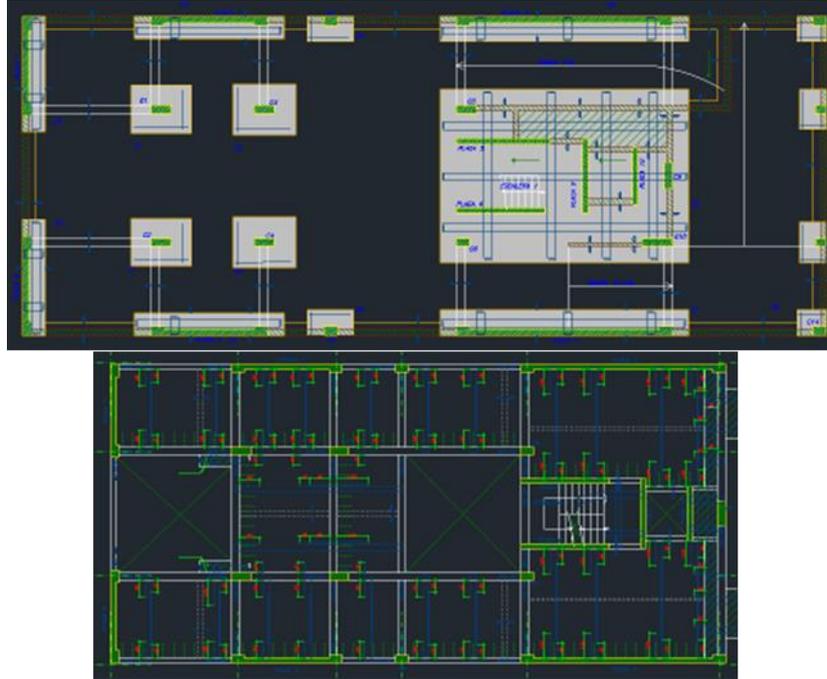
Plano estructural de planta 2D edificio Spuknit - Surco
